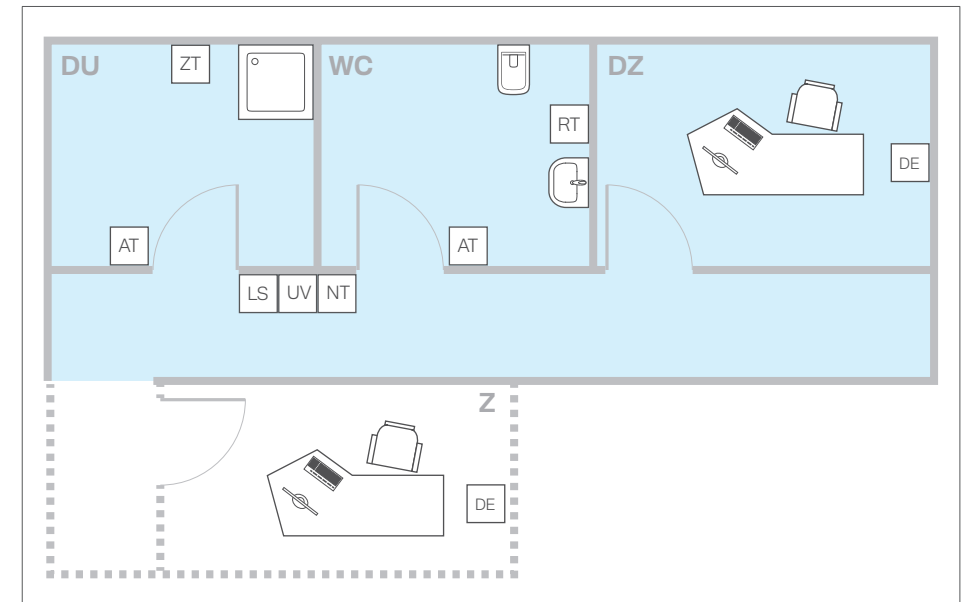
Grundriss Notruf-Set Erweiterung
